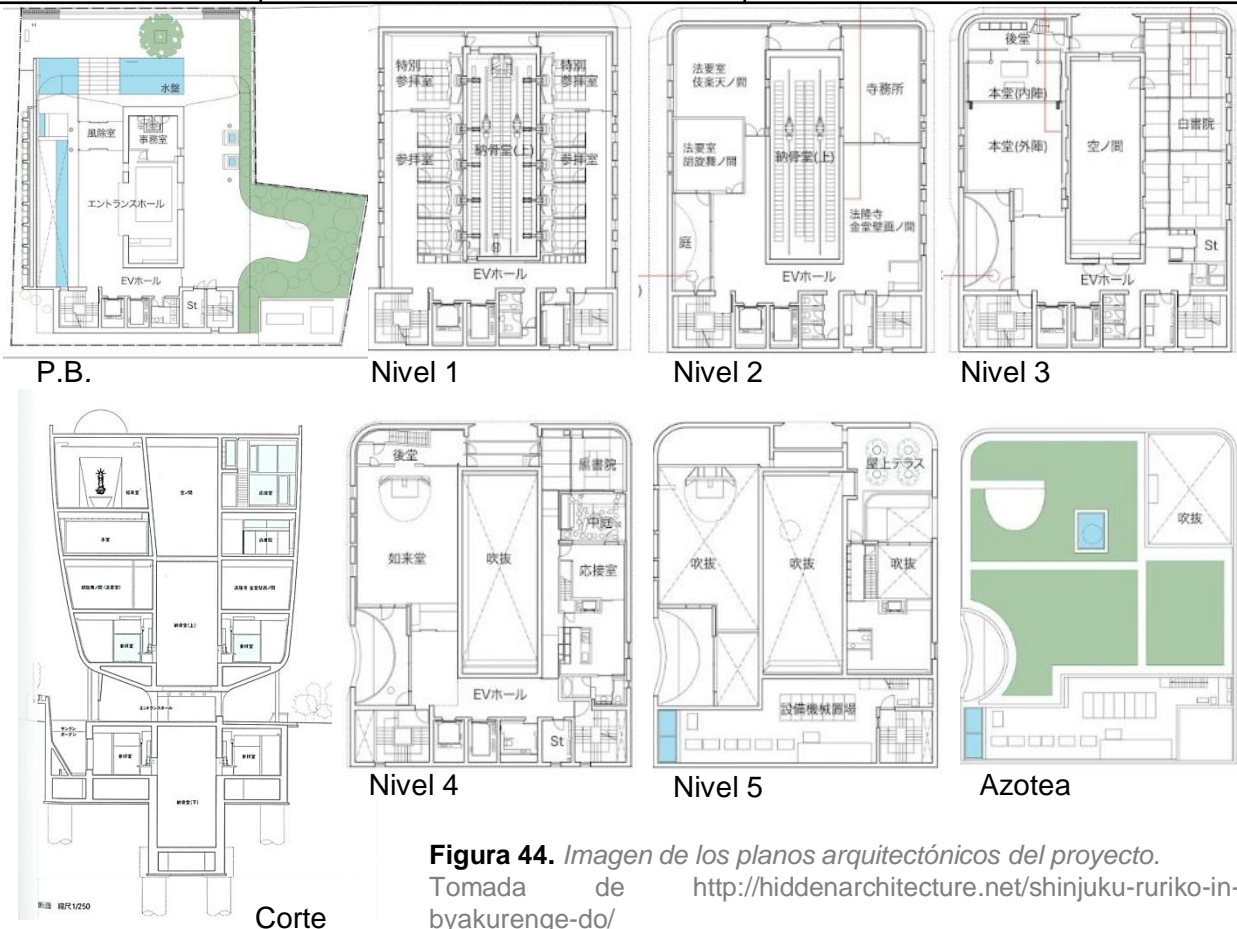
Imagen de los planos arquitectónicos del proyecto.
